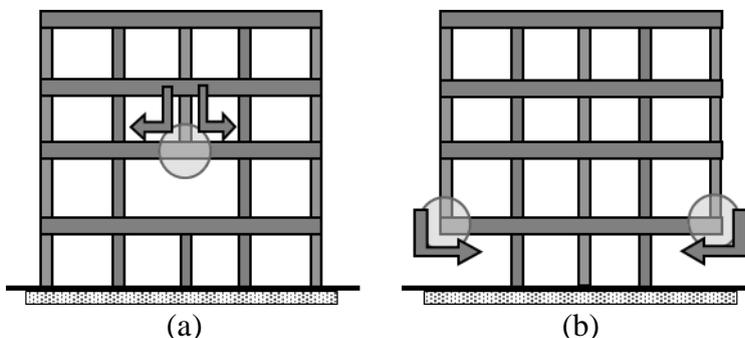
Distintos edificios con zonas de concentración de tensiones (a) con pilares apeados (b) con pilares que no continúan hasta la cimentación.
